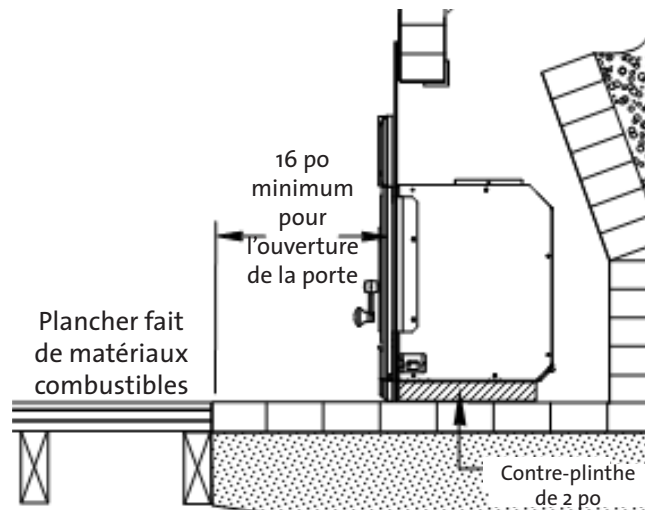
La protection est requise si l'âtre est au même niveau que le plancher fait de matériaux combustibles. La contre-plinthe doit être installée.
